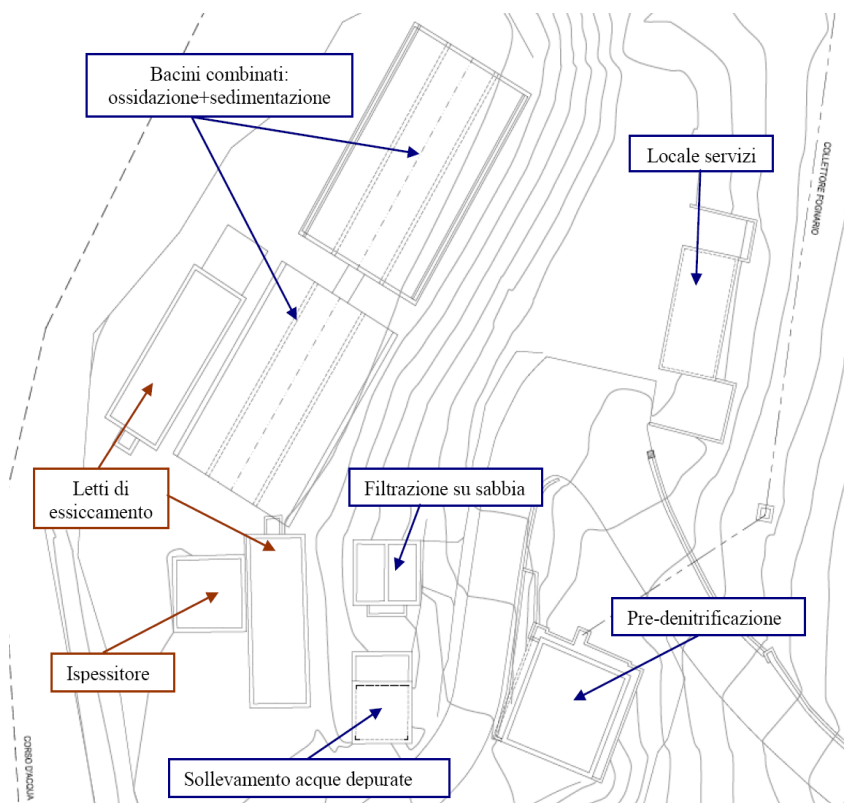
Planimetria dell'impianto di depurazione di Costa Paradiso (stato di fatto)
